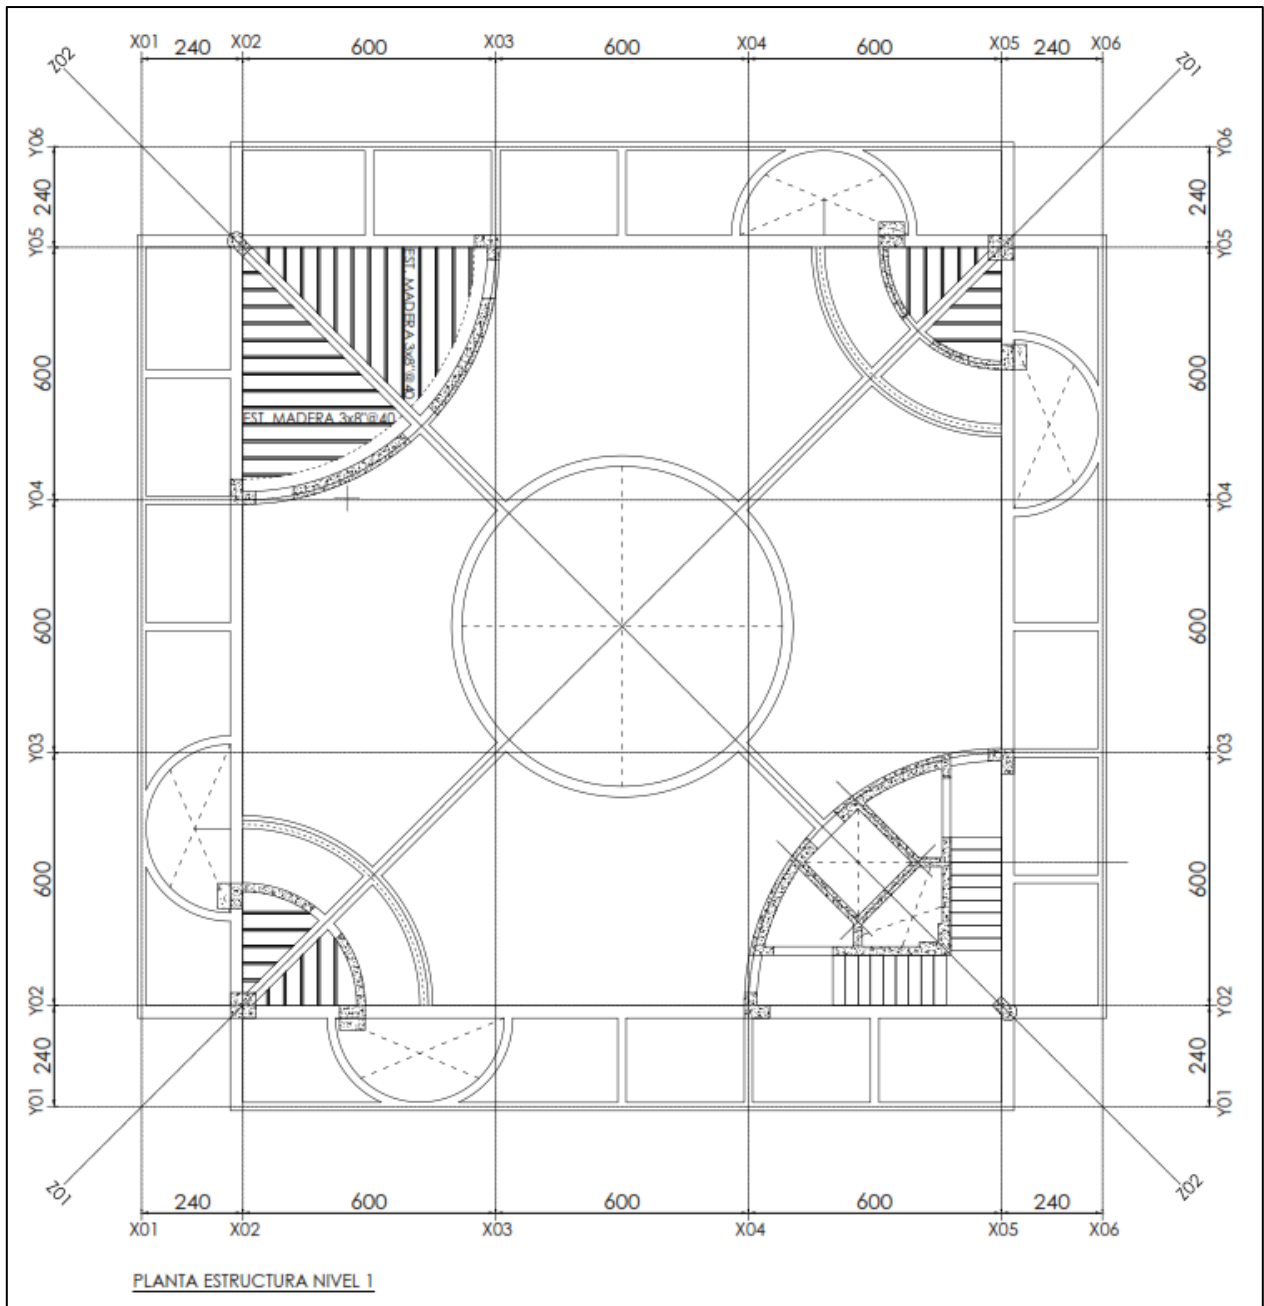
Estructuración en vigas de madera primer piso (cm)
